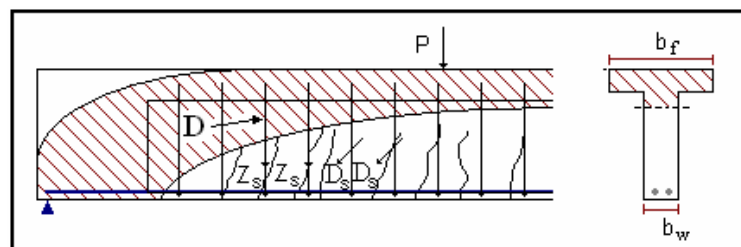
Comportamento estrutural de vigas de seção T (LEONHARDT & MÖNNING, 1977)
